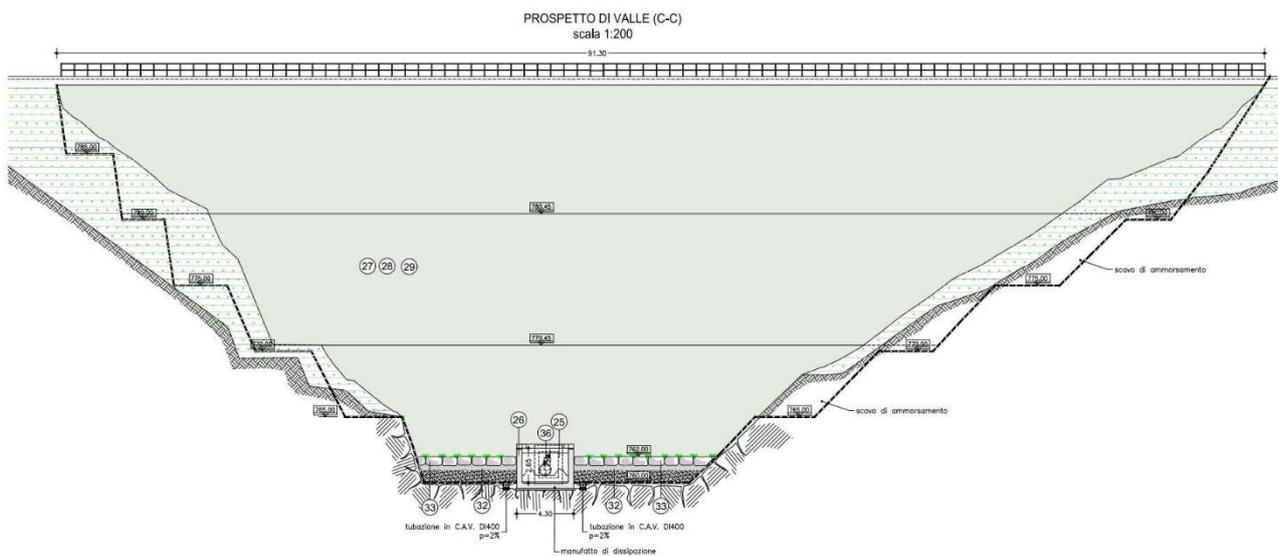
Prospetto del rinfianco previsto nel paramento di valle
